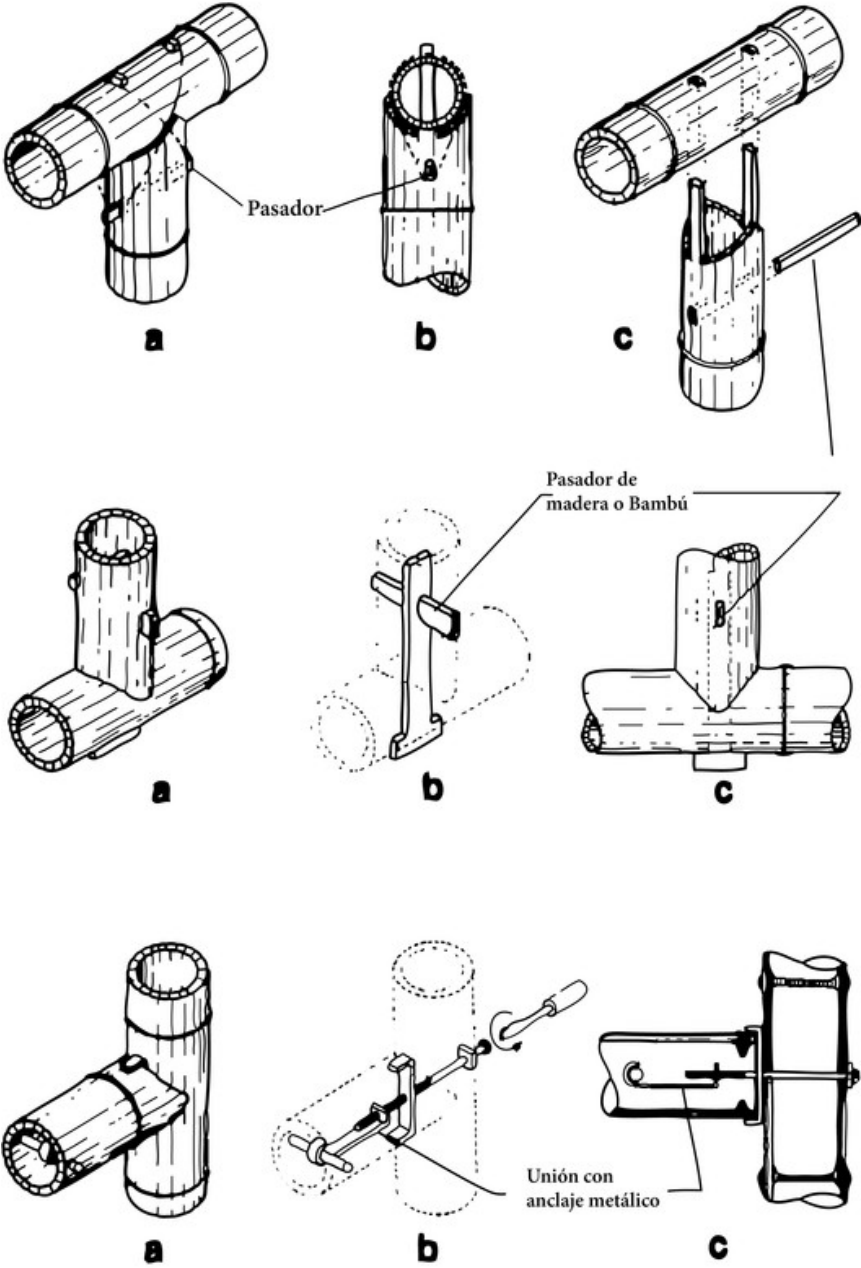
Unión con clavijas, anclaje de madera o anclaje metálico.
